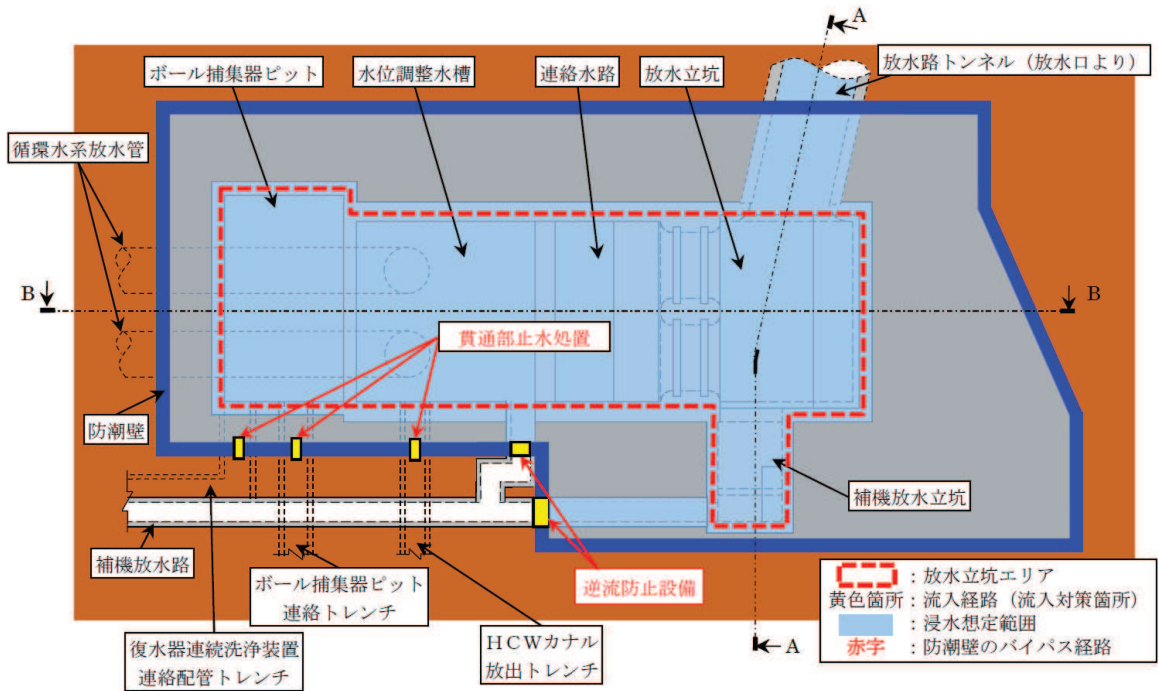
第 2 号機 放水立坑 流入対策配置図 (平面図)
